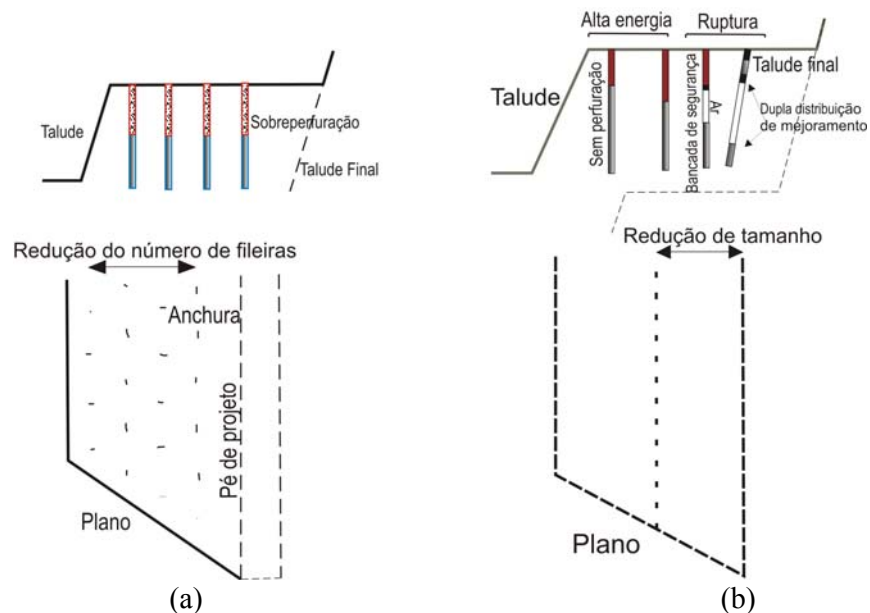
(a) Modificação da detonação de produção (b) Detonação alisada com furos verticais e ângulo inclinado (modificado – Hagan & Bulow, 2000).
